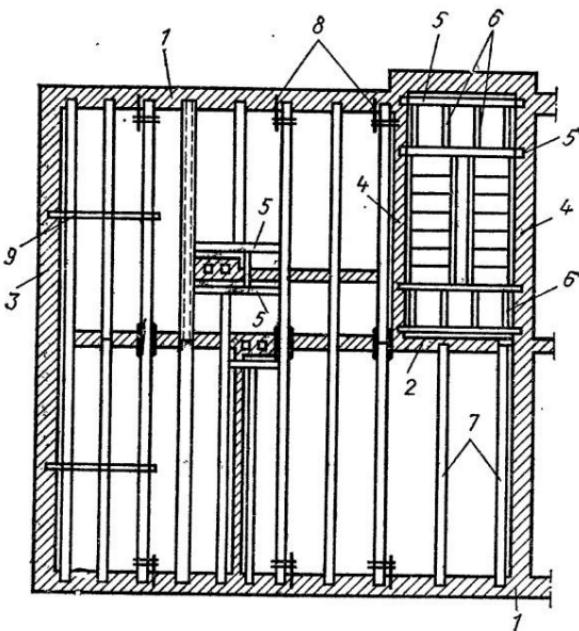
Анкеровка балок междуэтажного перекрытия на наружных и внутренних (капитальных) стенах
